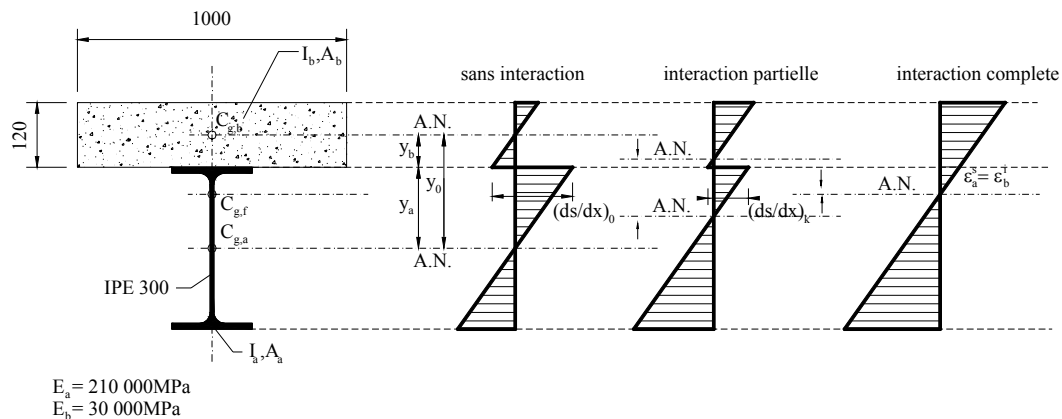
Axes neutres dans la section mixte selon le type d'interaction acier béton
